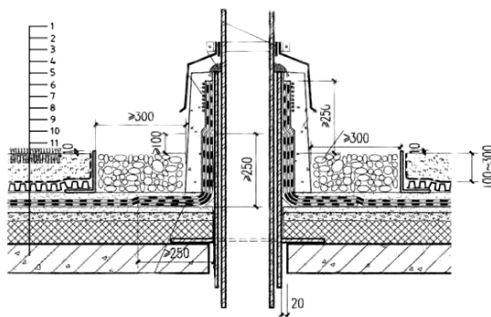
管道出屋面构造图（管径 ≤ 300 ）
